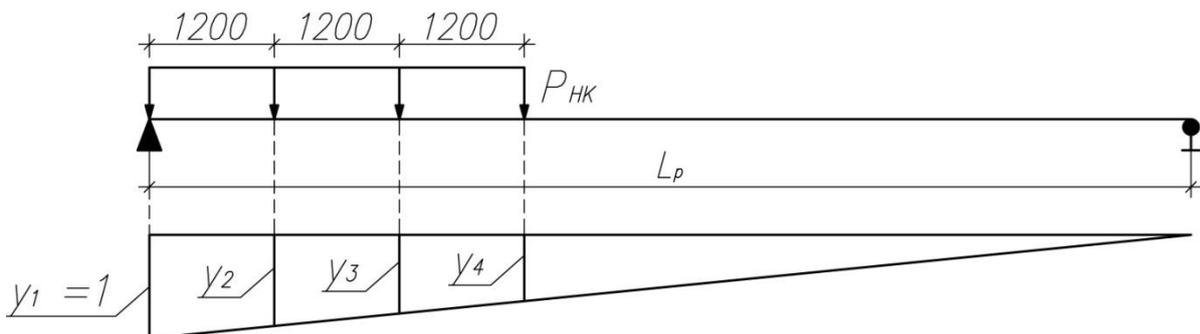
Продольная установка подвижной нагрузки НК-80 на линии влияния для определения поперечного усилия
